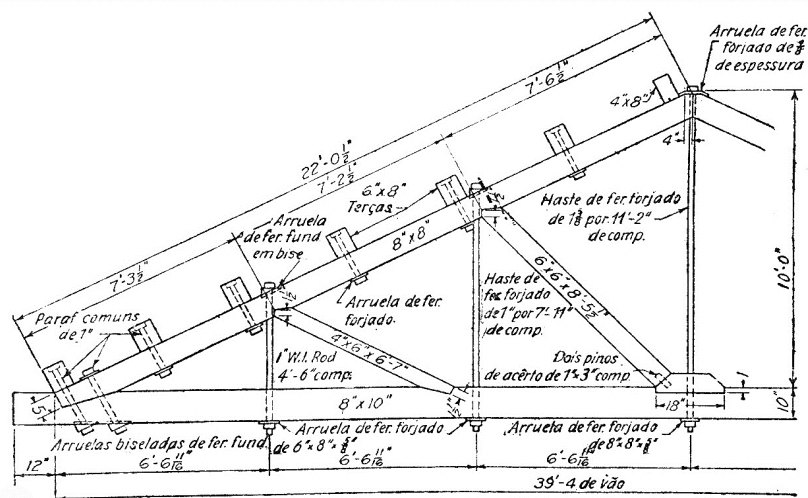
Tesoura e terças de madeira para telhas metálicas
